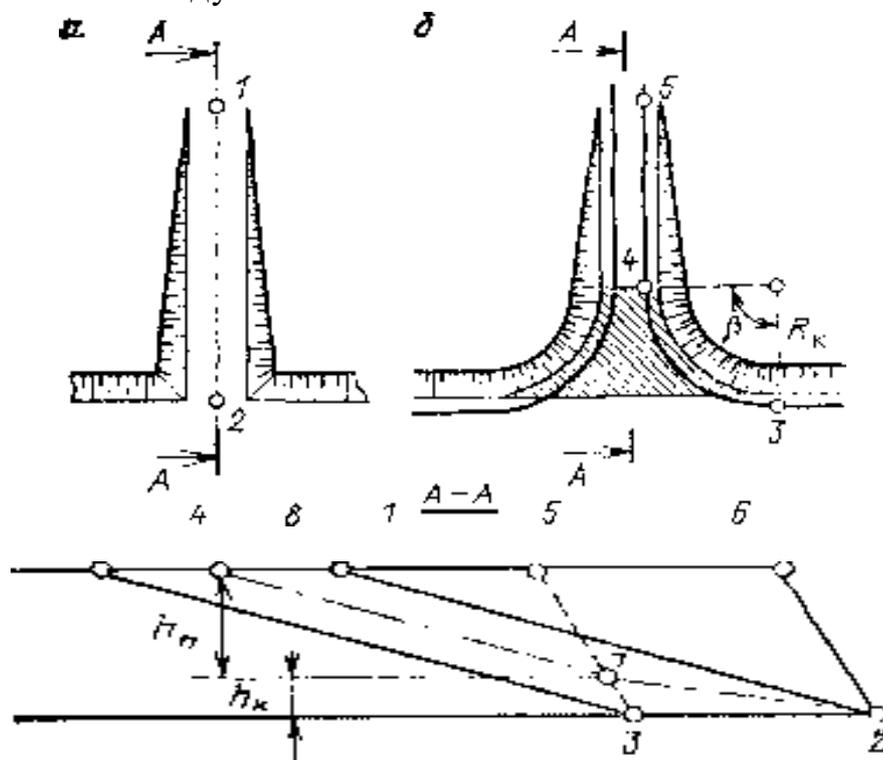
Схемы примыкания капитальной траншеи к горизонту
